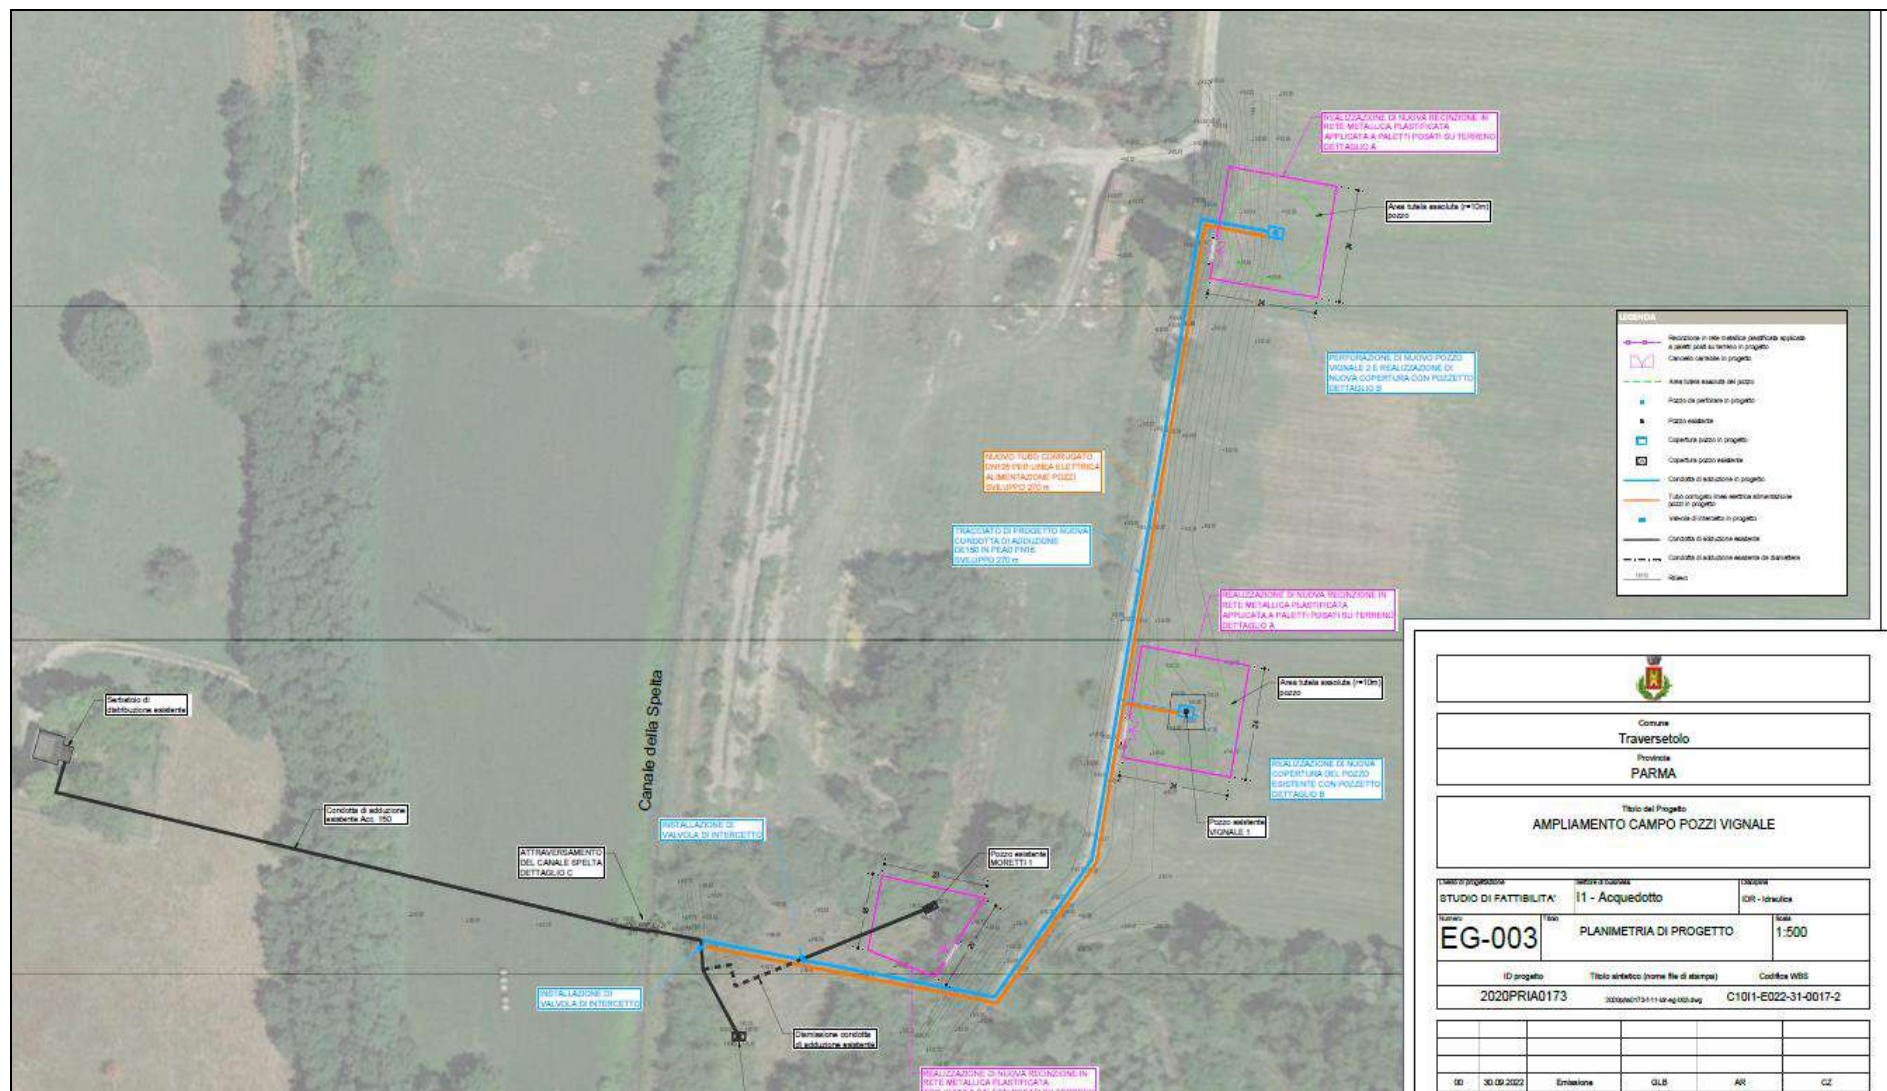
Planimetria di progetto ampliamento campo pozzi di Vignale
